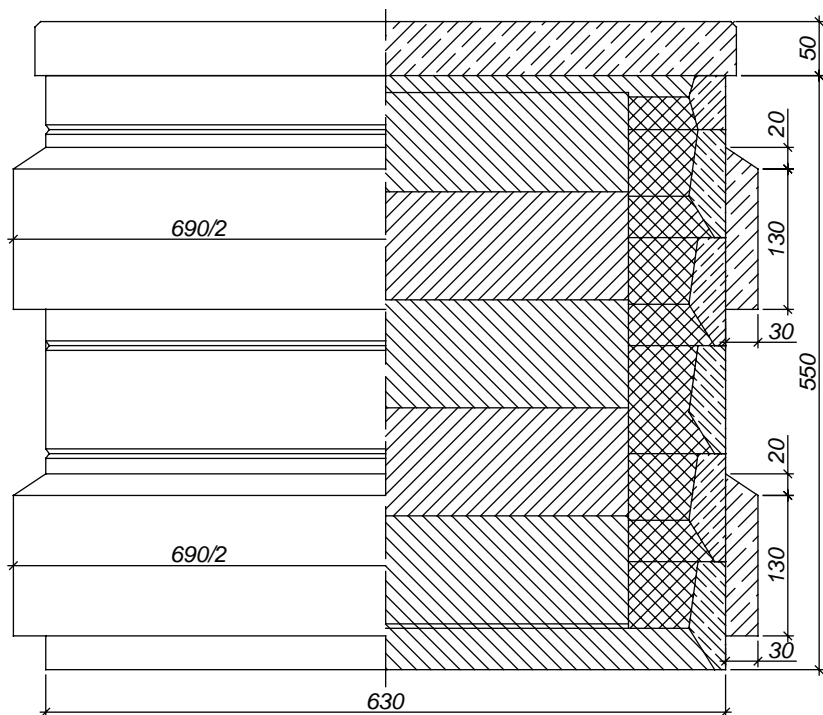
Схема усиления промежуточной опоры железобетонными поясами
